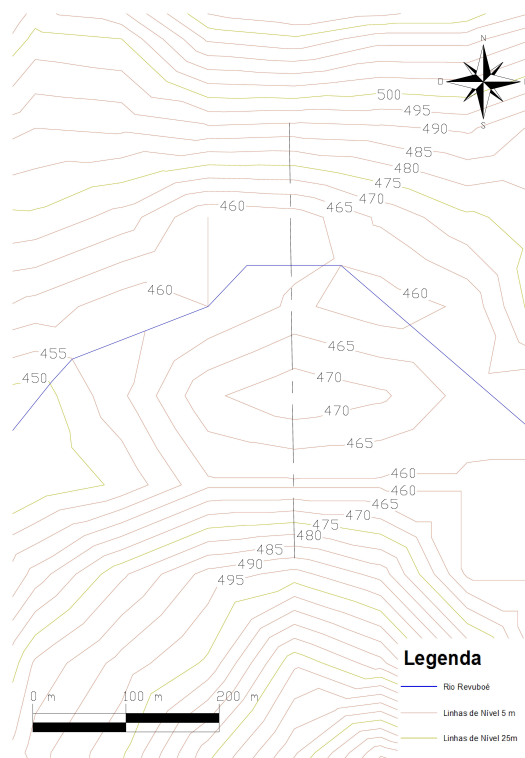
TOPOGRAFIA DO LOCAL DE IMPLANTAÇÃO DA ALTERNATIVA 9, E EIXO PRINCIPAL DA BARRAGEM
